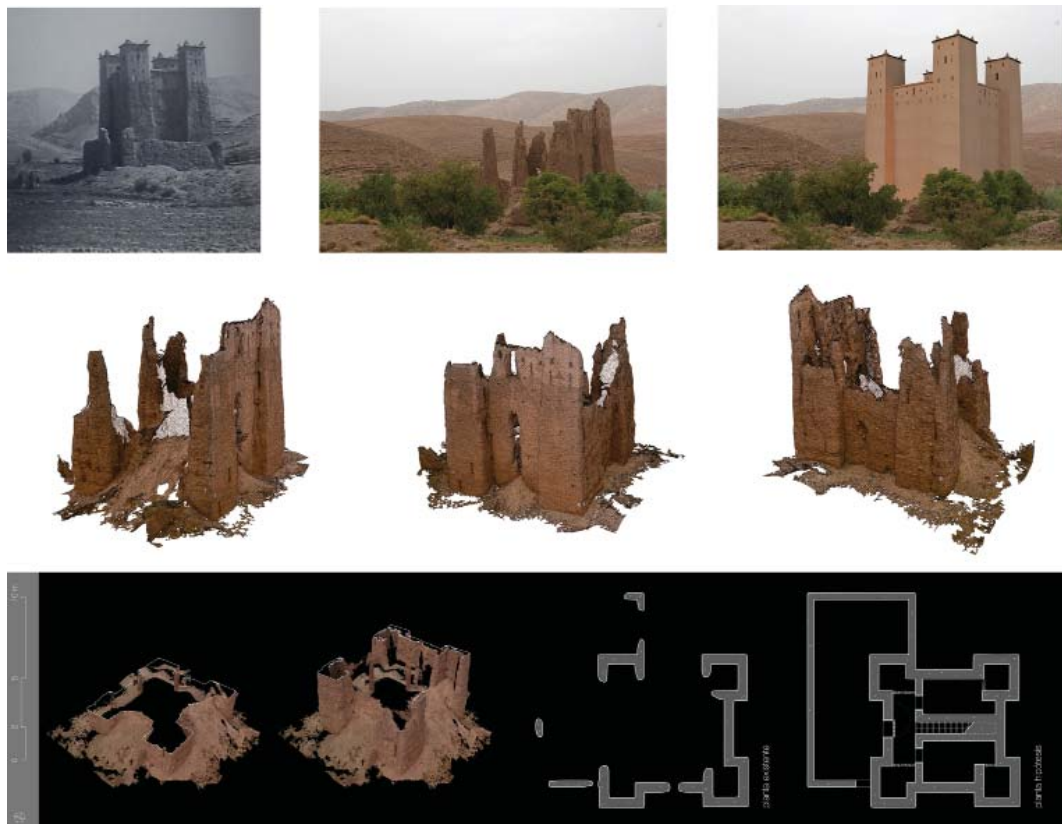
Kasbah “Guardián del Agua”. Fotografía de Jacques–Meunié, fotografía actual e hipótesis reconstructiva. Vistas modelado 3D. Secciones modelo 3D, planta actual e hipótesis planta. Fuente: Grupo UPV.
